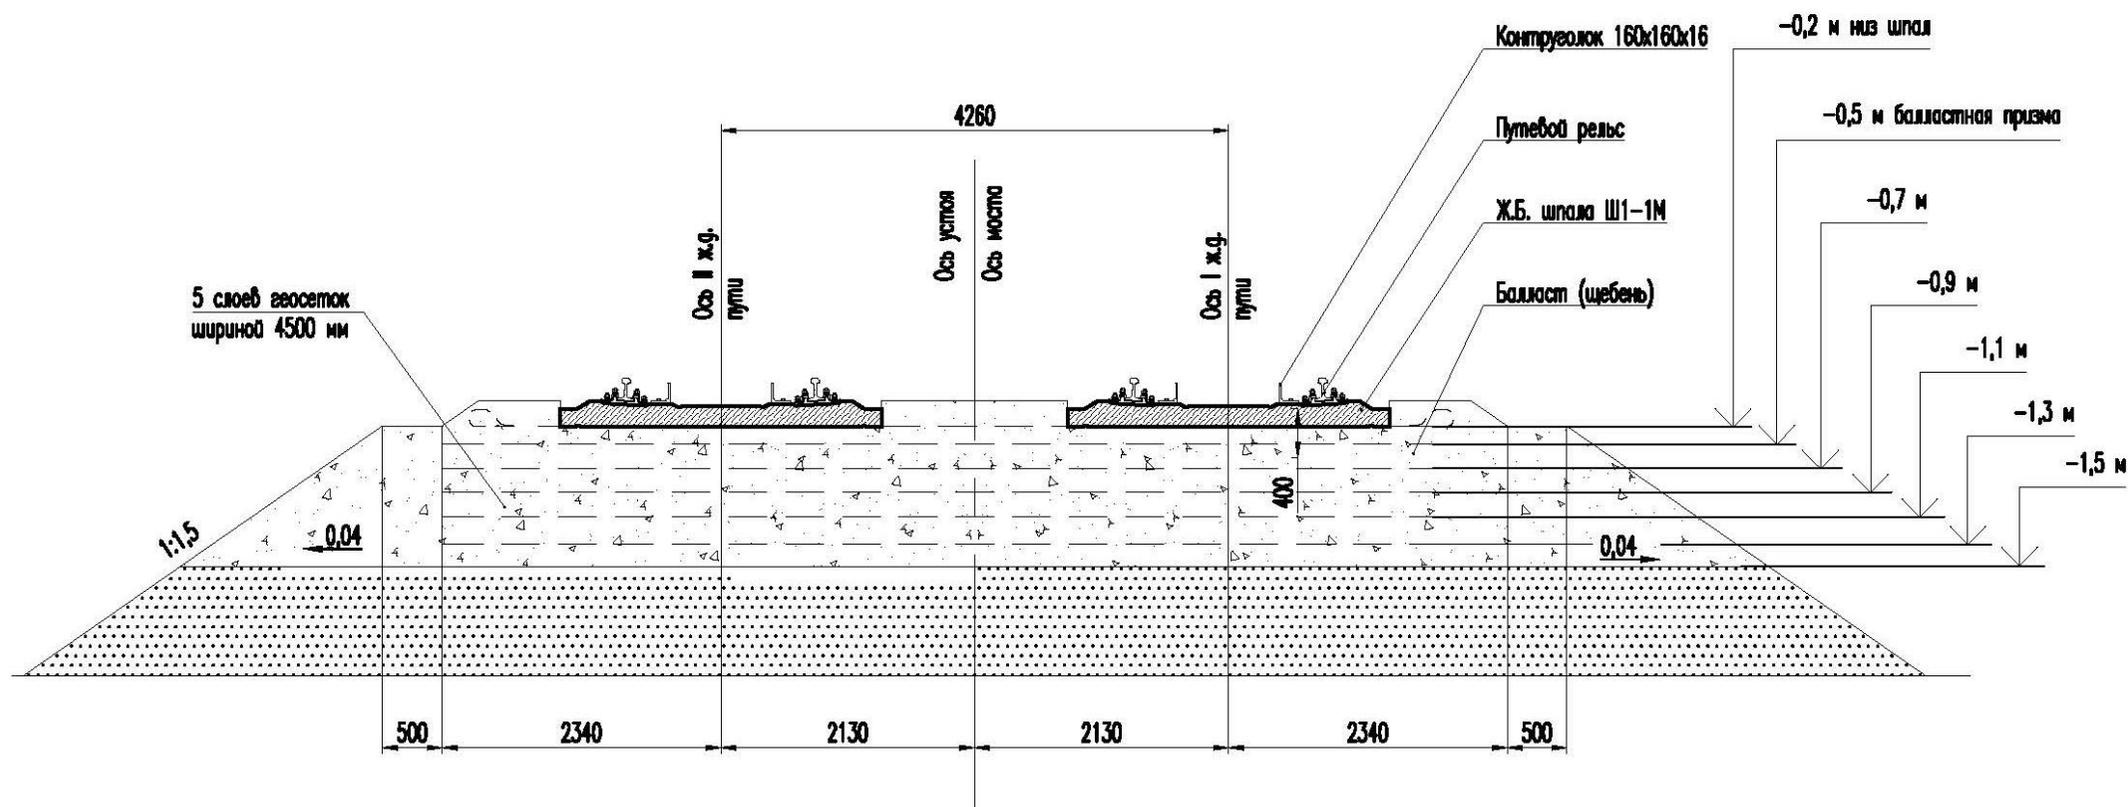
Схема укладки слоев геосетки при замене грунтов верхней части насыпи на щебень, на переходном участке перед пролетным строением
